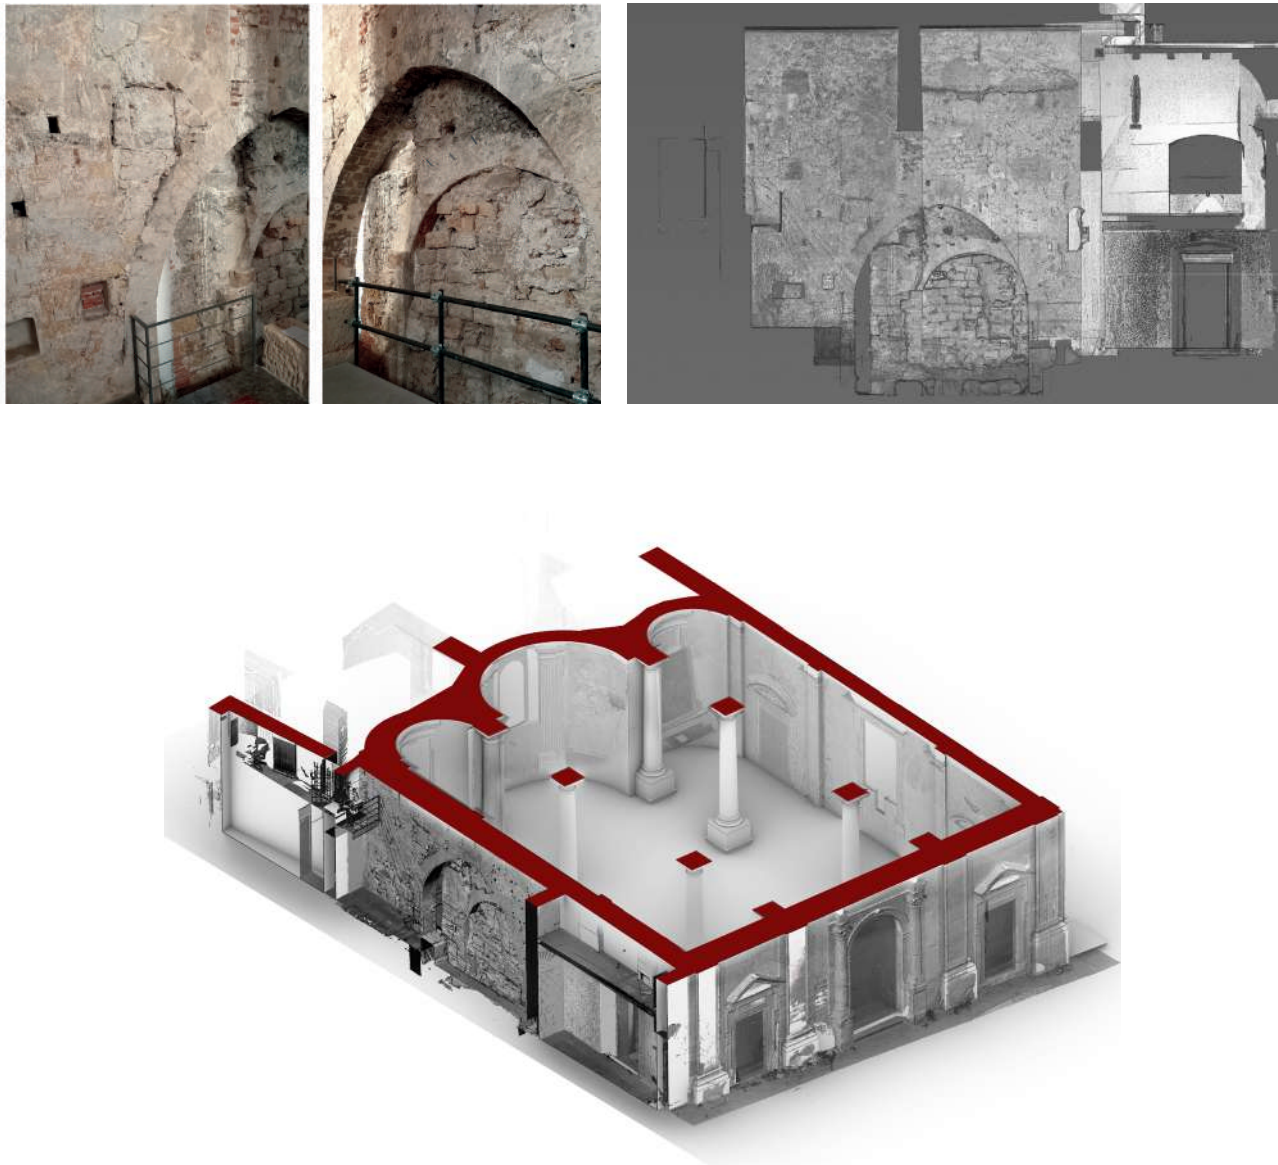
Palermo. Chiesa di S. Andrea Apostolo: vedute del muro nord lato 'esterno' visibile dai locali addossati (in alto) (foto dell'autrice); vista ortografica verticale della point cloud effettuata dalle acquisizioni di rilievo della stessa parete (in basso); spaccato prospettico orizzontale (a destra) (elaborazione grafica di Laura Barrale)
